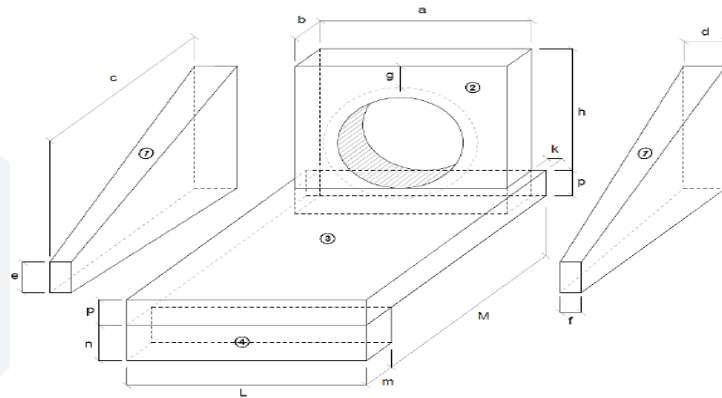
Detalhamento das dimensões da boca de bueiro simples com alas retas
